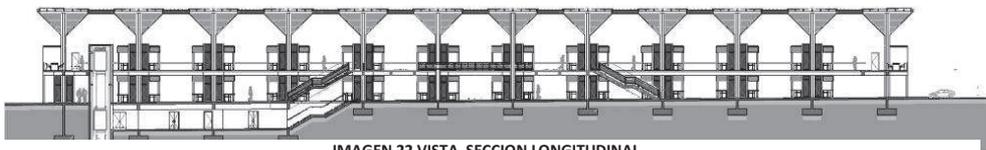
VISTA SECCION LONGITUDINAL
